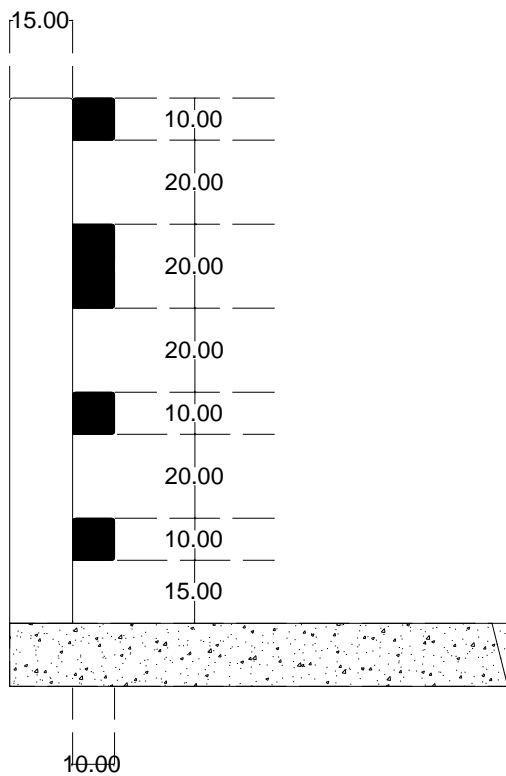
Vista transversal de baranda con medidas en centímetros. Elaborado por: Autores.
